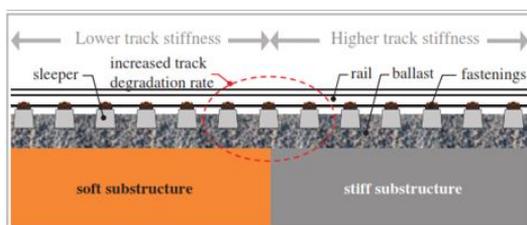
Problemática asociada a las transiciones estructura-terraplén y vía en placa-vía sobre balasto,(FUENTE: Design and construction of backfills for railway track transition zones [1])
